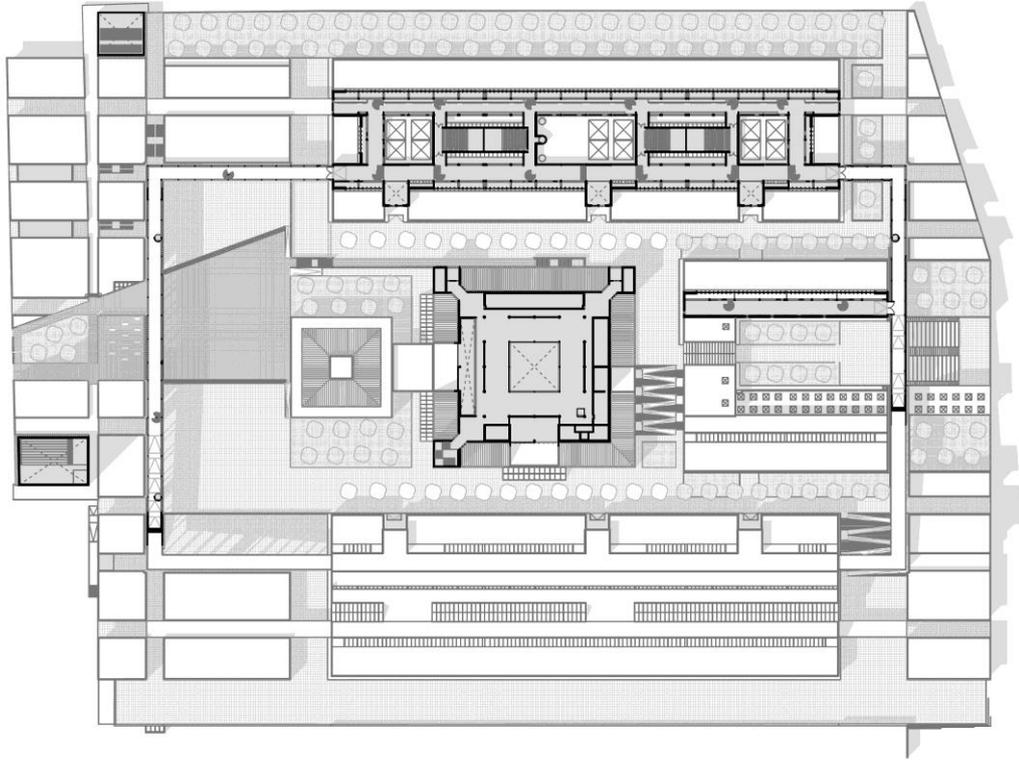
Planta do piso 2 da Faculdade de Arquitectura
